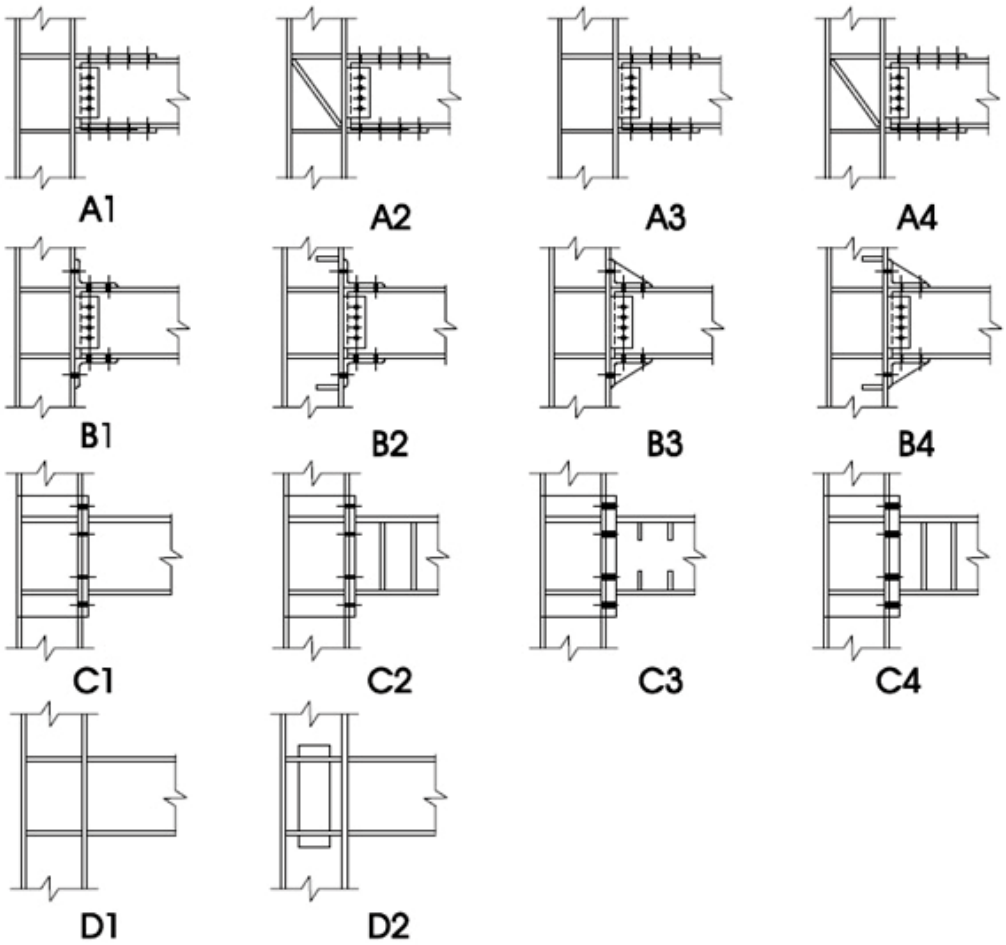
Tipos de uniones viga-pilar ensayados por Mazzolani y otros. (Fuente: ITEA, 2008)
